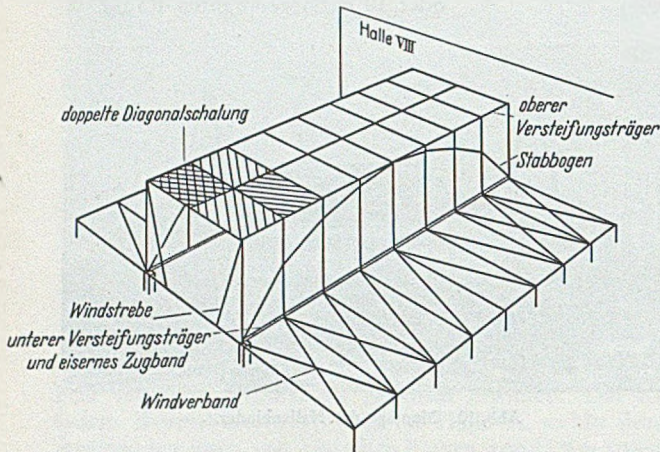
Schema der Dachkonstruktion der Halle VIIIa.
